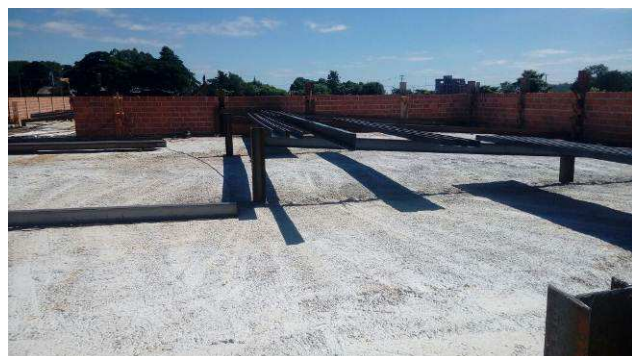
C: Estrutura metálica de cobertura - pórticos e terças.
